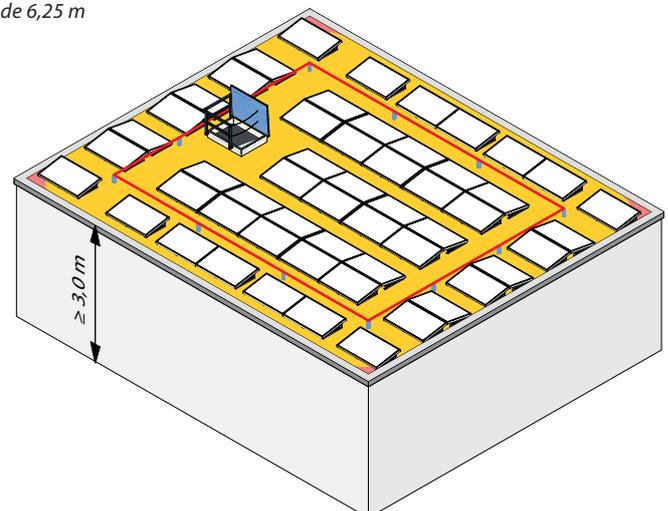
Classe d'équipement 2 : Système de retenue avec des installations solaires couvrant toute la surface
